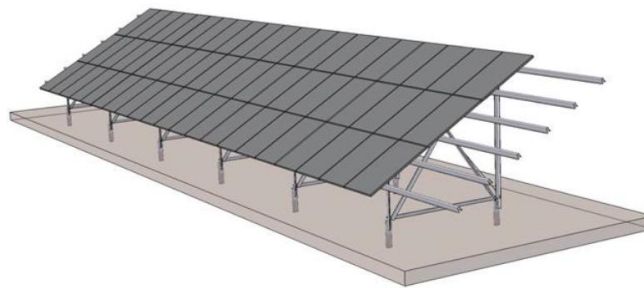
Estructura tipo fija para soporte de los paneles
